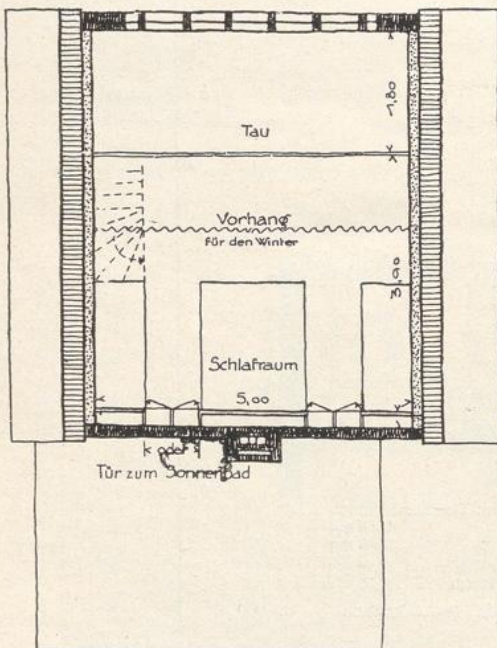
Grundriß des Dachgeschosses. (1:100)
